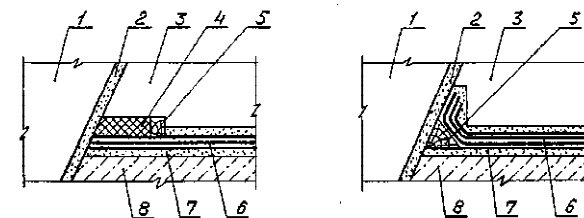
Сопряжение оклеечной гидроизоляции дна опускного колодца с цементной гидроизоляцией стен:
